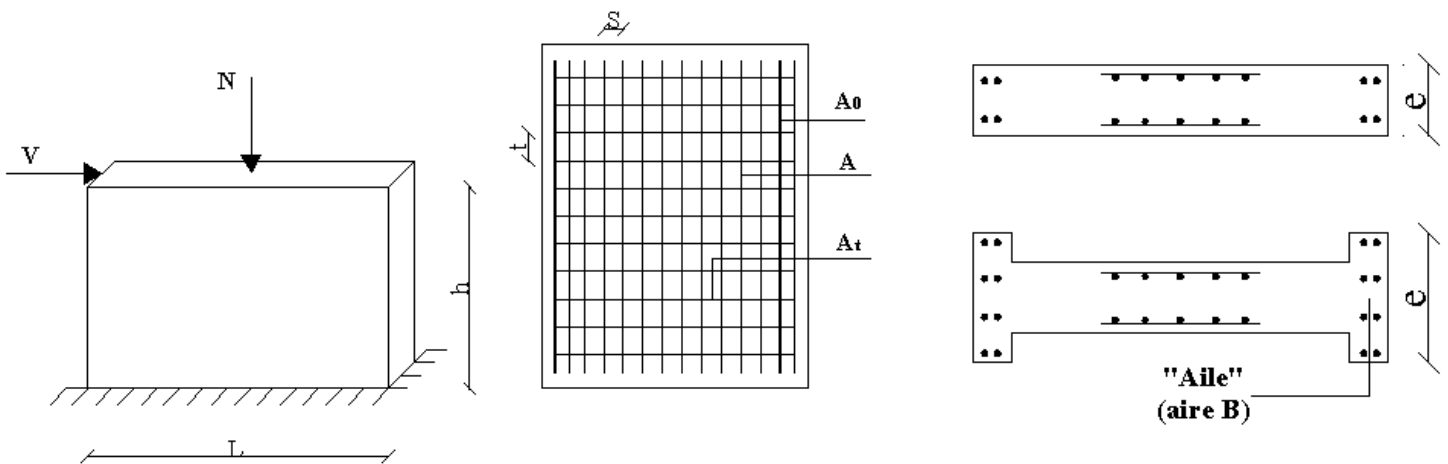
Disposition du ferrailage d'un voile et un schéma d'un voile pleine
